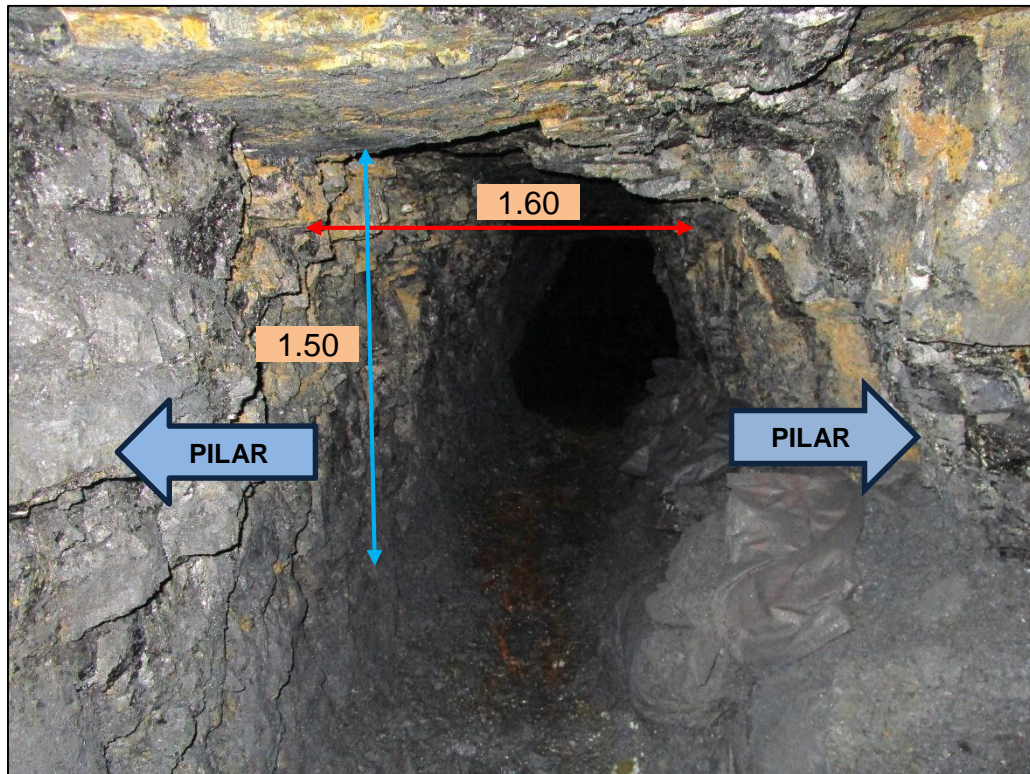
Cámaras y Pilares en Avance dentro de la Labor Minera 1.
